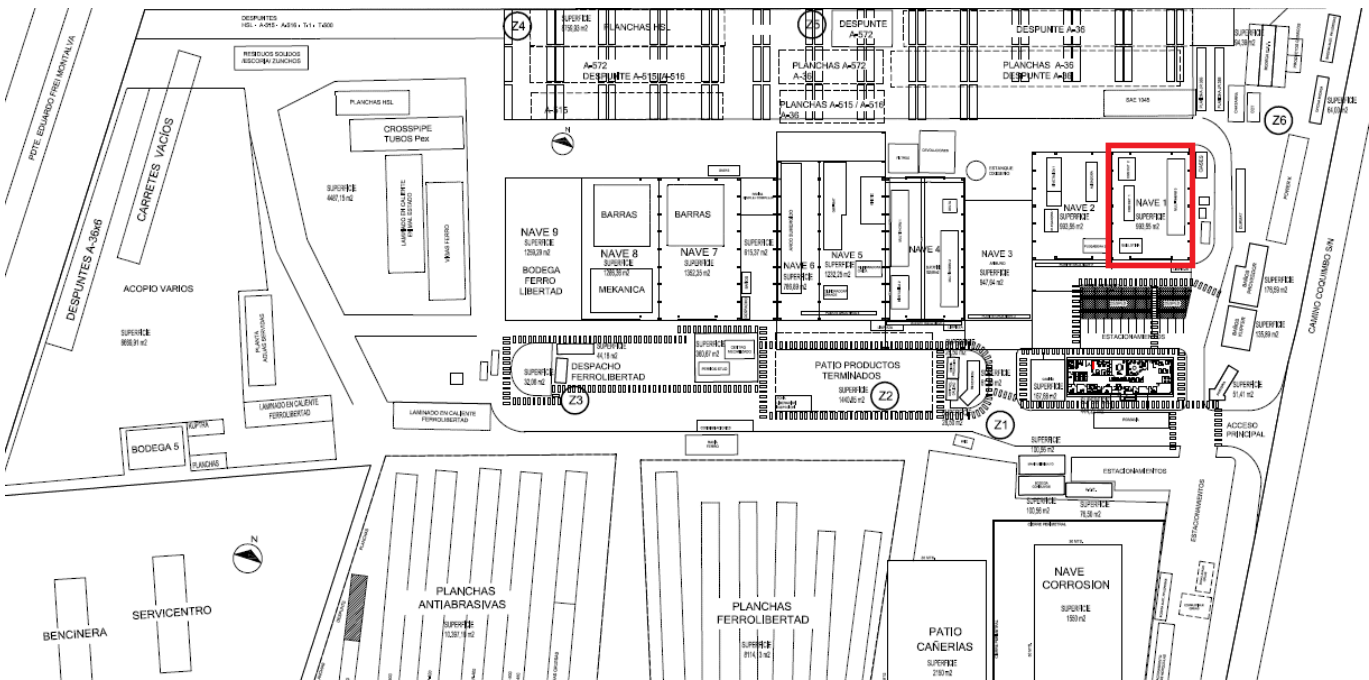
Lay Out de la planta Fuente: Küpfer Hnos S.A.
